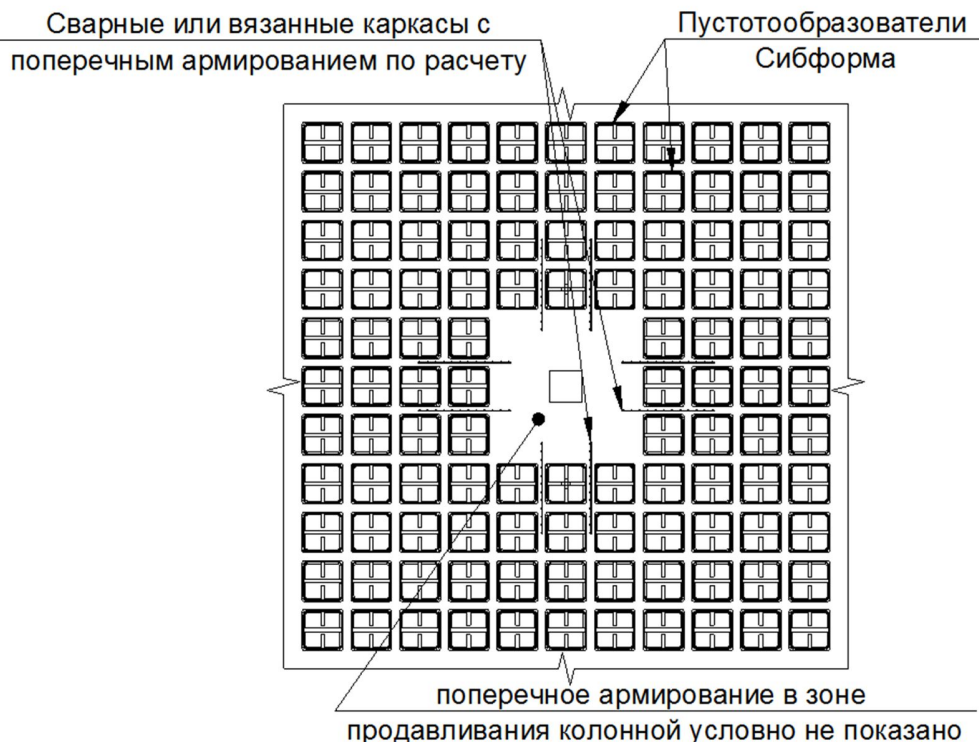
Схема возможного размещения пустотообразователей и плоских каркасов с поперечным армированием между ними
